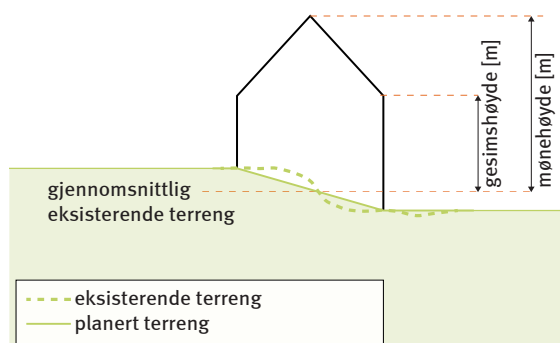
Snitt hvor gesims- og mønehøyde samt høyde på eksisterende og planert terreng er angitt med kotevall.
